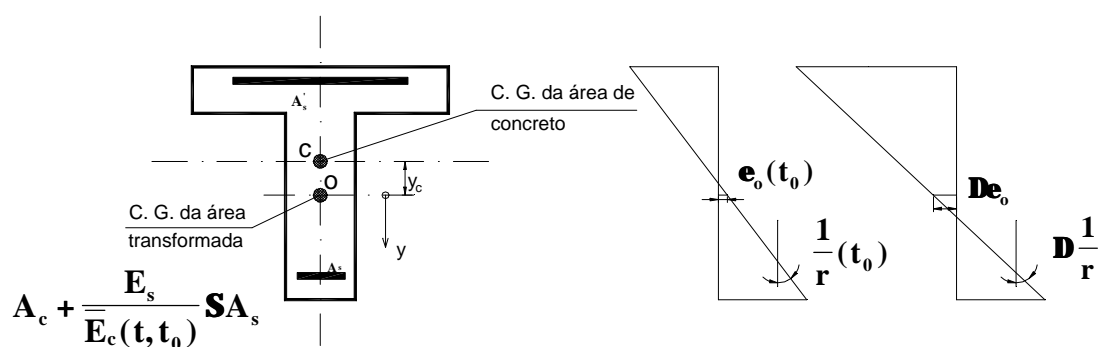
Efeitos da fluência e retração numa seção não fissurada de concreto armado.
